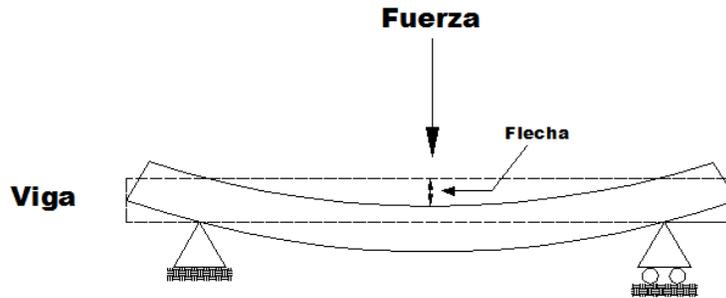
Deflexión en viga por la aplicación de una Fuerza.
